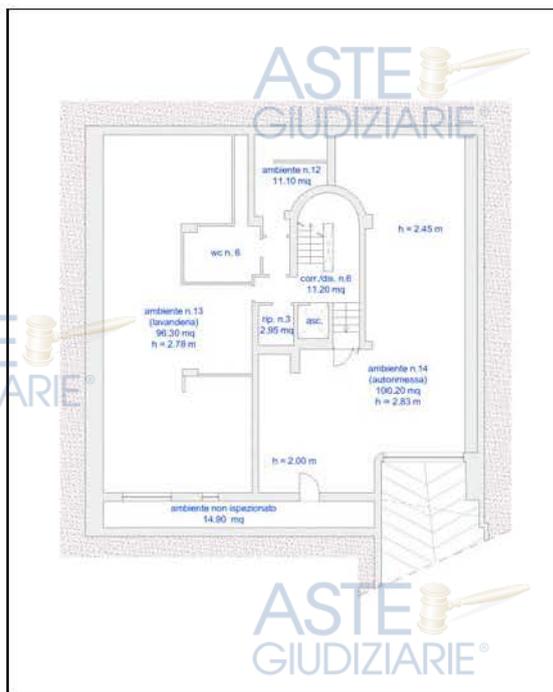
Planimetria stato dei luoghi 2°P del 17/06/2021
